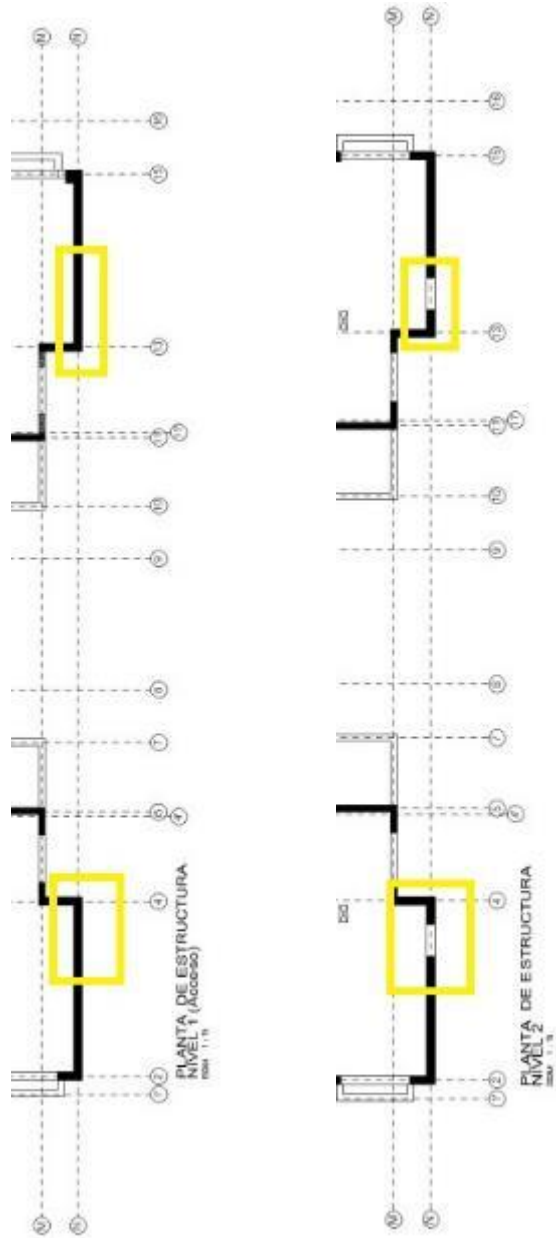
Planta 1° Piso eje N Figura 63: Planta 2° piso eje N
